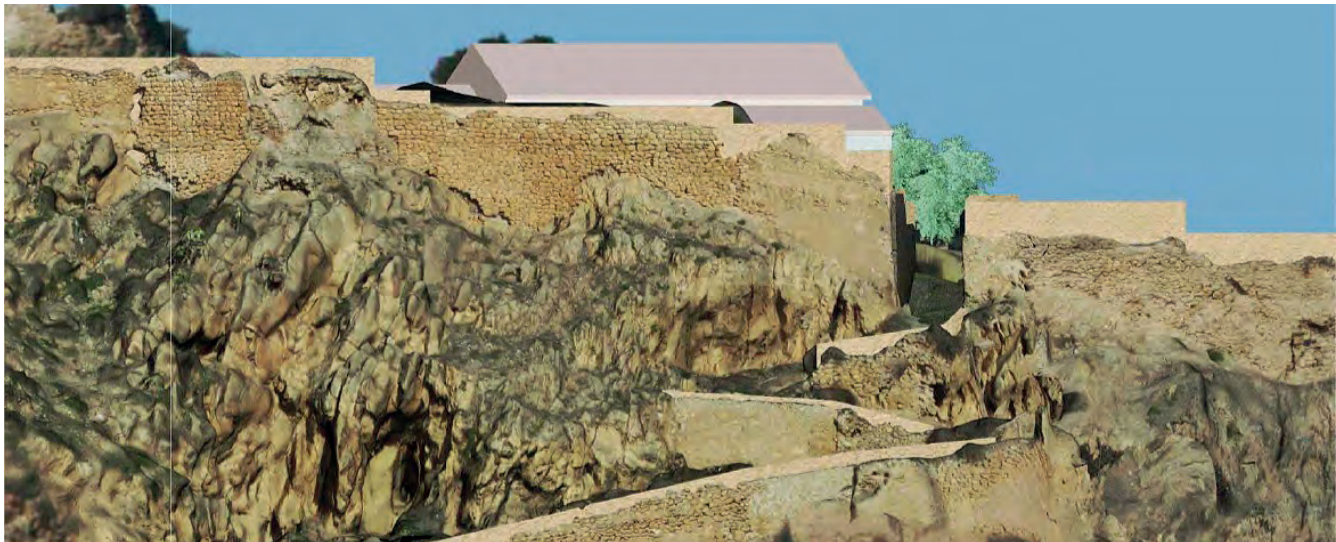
Alzado sur del proyecto donde se refleja la recuperación del camino de acceso a la puerta de San Clemente, con posible uso tras las obras de restauración.
